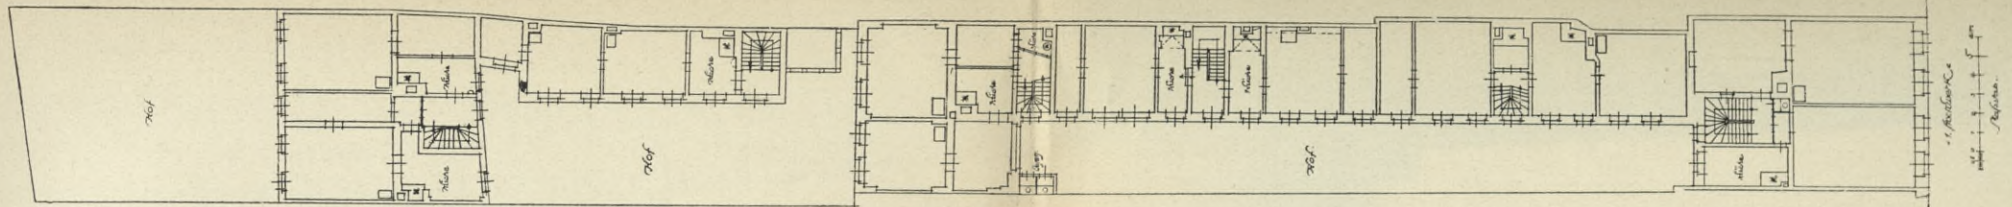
Stralauer Str. 47. Nach eigener Aufnahme
